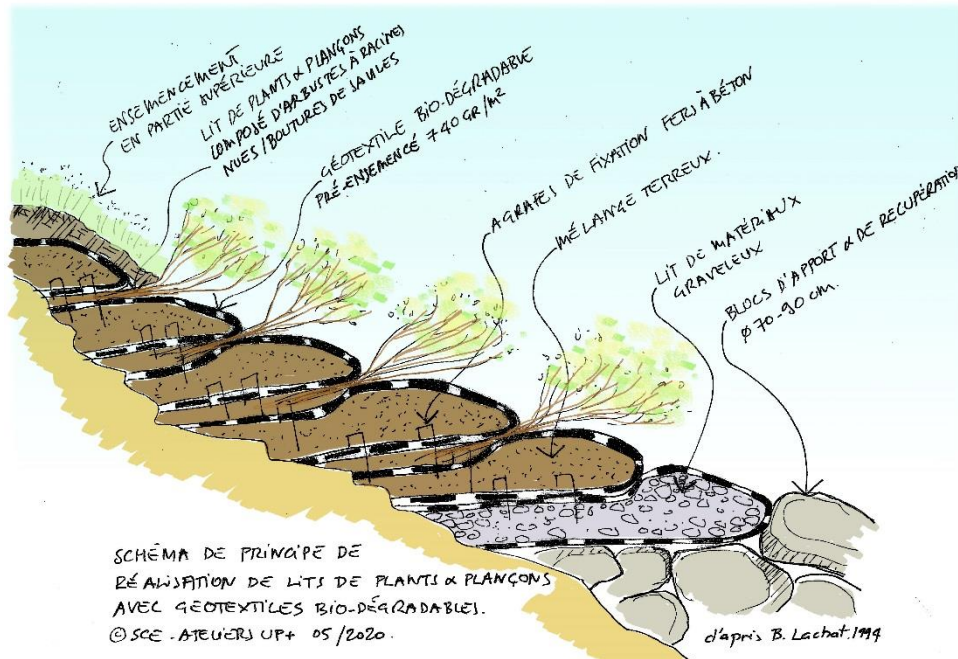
Croquis concernant le détail des plants et plançons à installer en amont rd du pont
